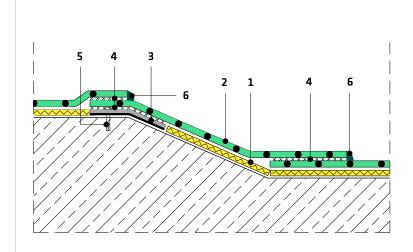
| Übergang Wand-Boden, horizontal - Erweitertes Verlegesystem mit Bodenfixierung
